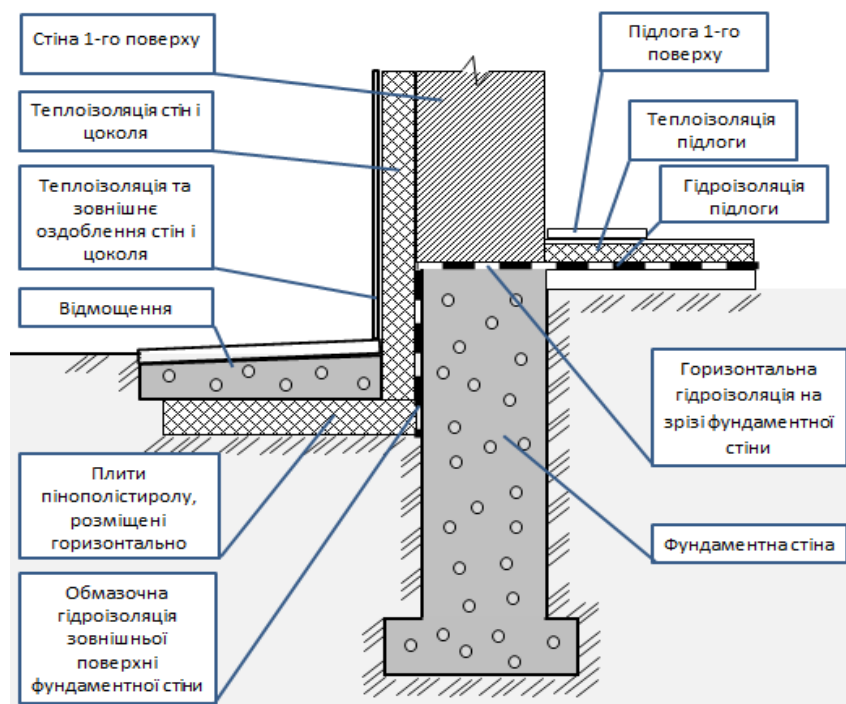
Утеплення фундаменту плитами полістиролу, які розміщені горизонтально впритиск до зовнішньої поверхні фундаментної стіни
